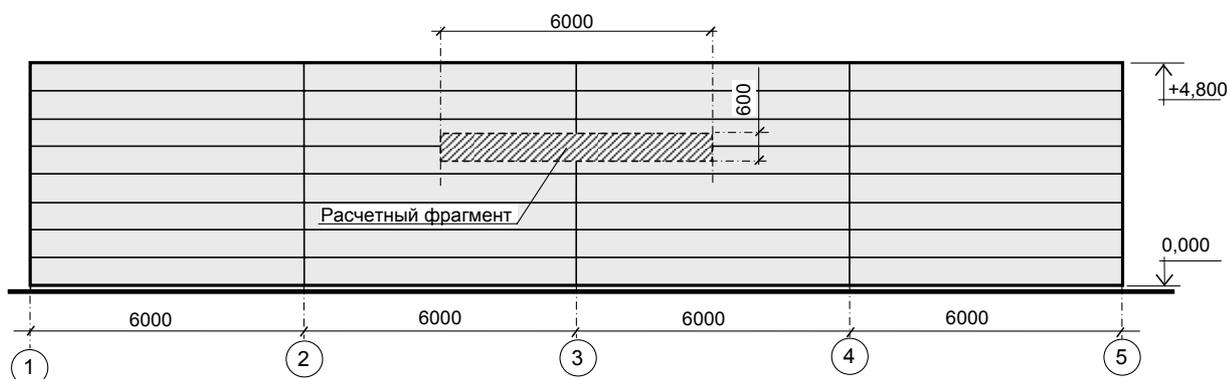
Схематичный фасад проектируемого здания (к примеру Е1)
